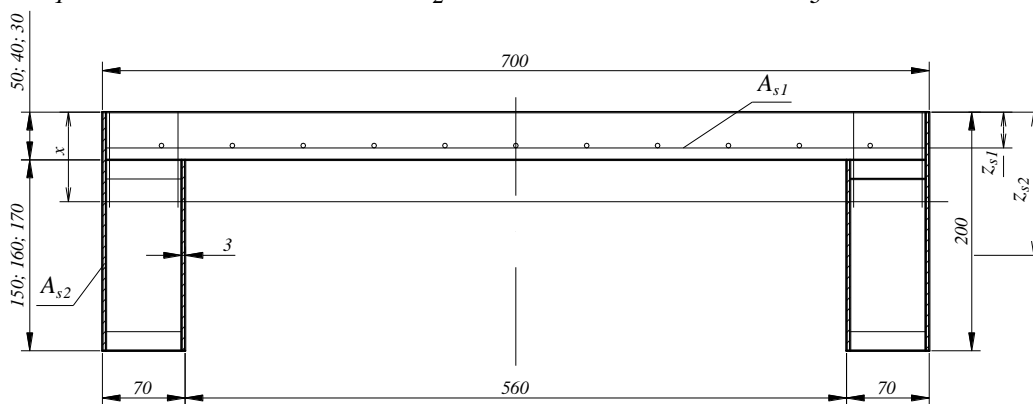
Розрахункова схема залізобетонної плити, підкріпленої сталезалізобетонними ребрами, серій БТ-2-1, 2, 3
